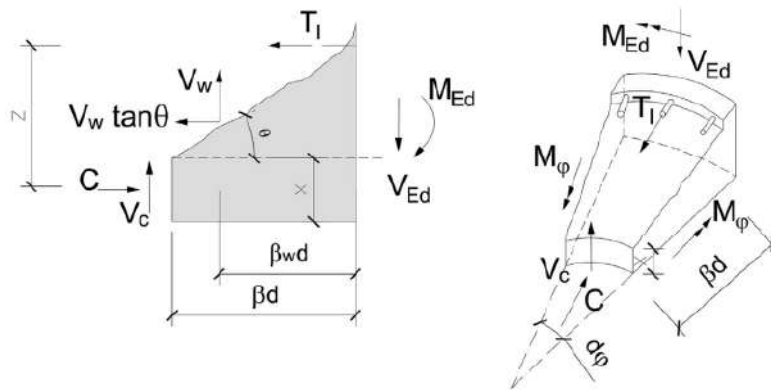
Equilibrio de fuerzas en una cuña de hormigón por debajo de la fisura
